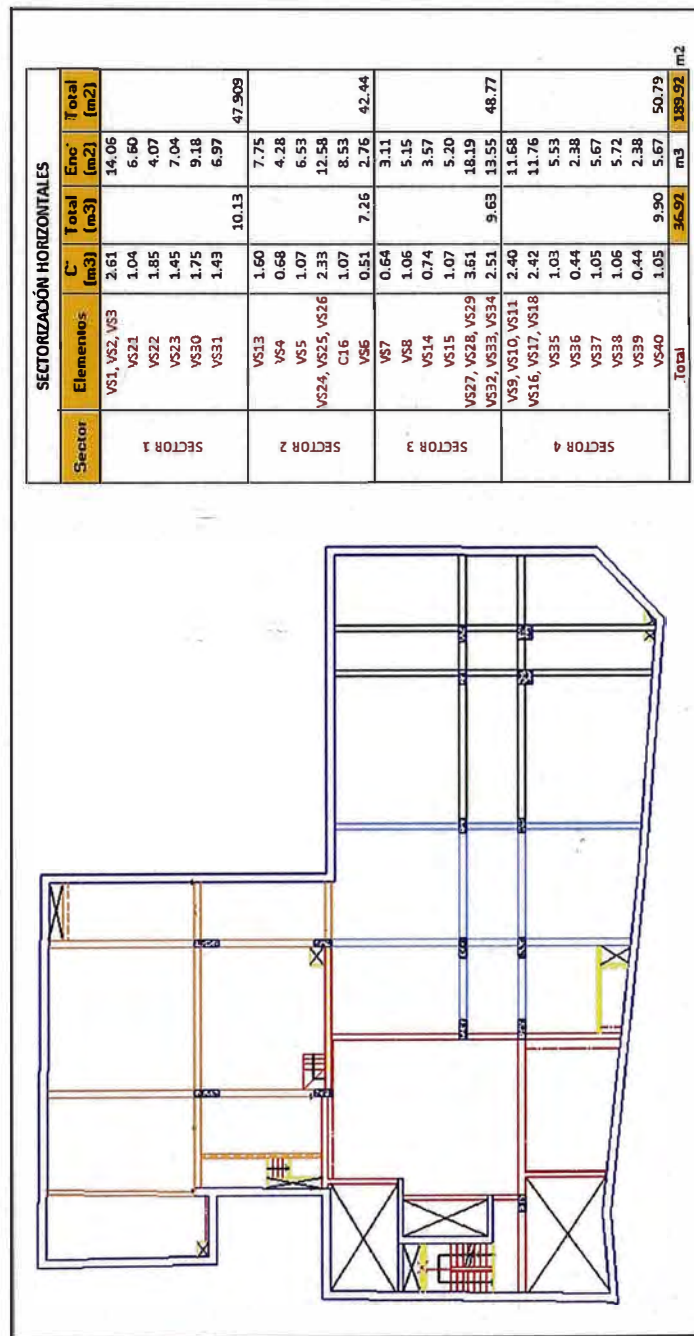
Sectorización de elementos horizontales: vigas.
